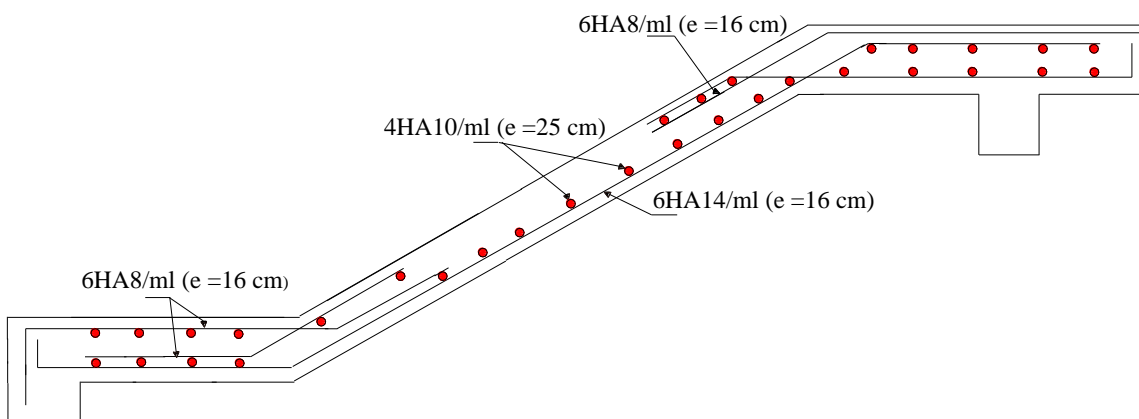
Schéma du ferrailage de l'escalier type 2.
